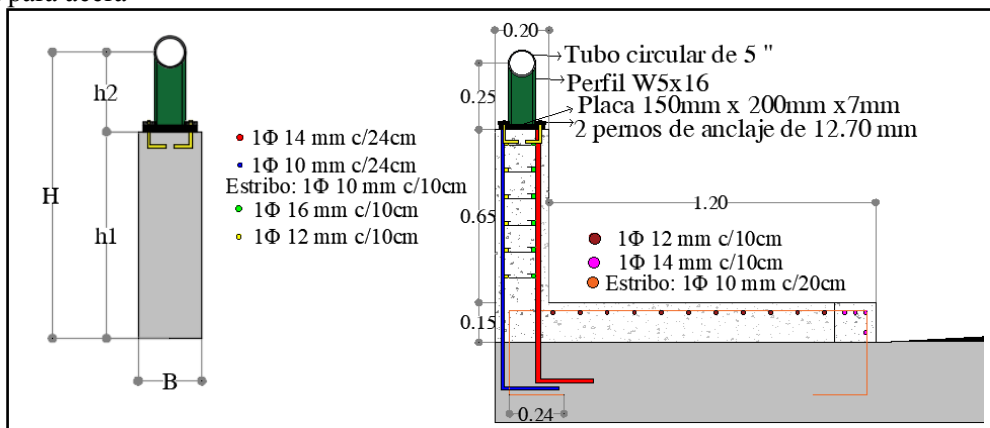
Dimensiones y armado inicial propuesto para la protección lateral
